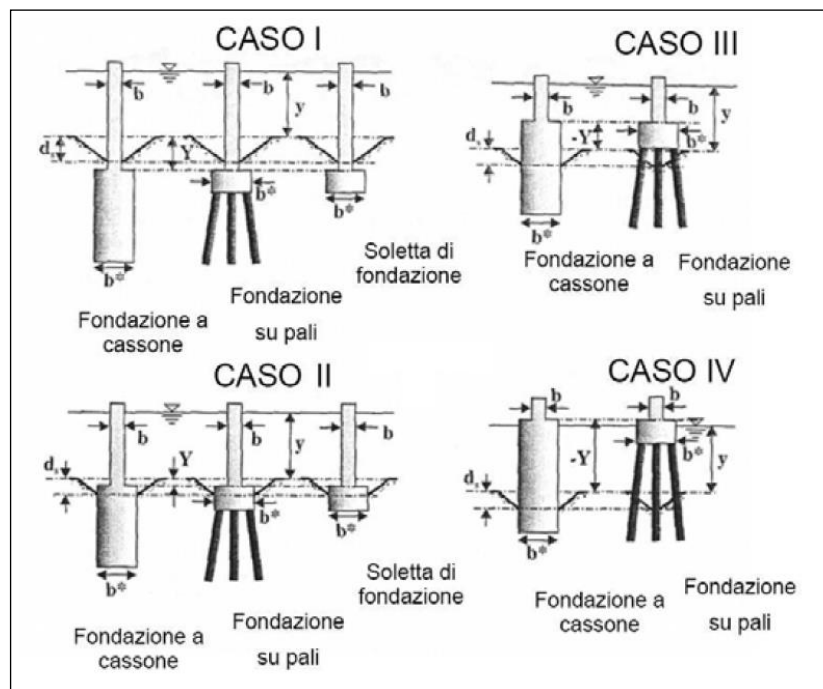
Differenti tipologie di pile e delle corrispondenti fondazioni.
